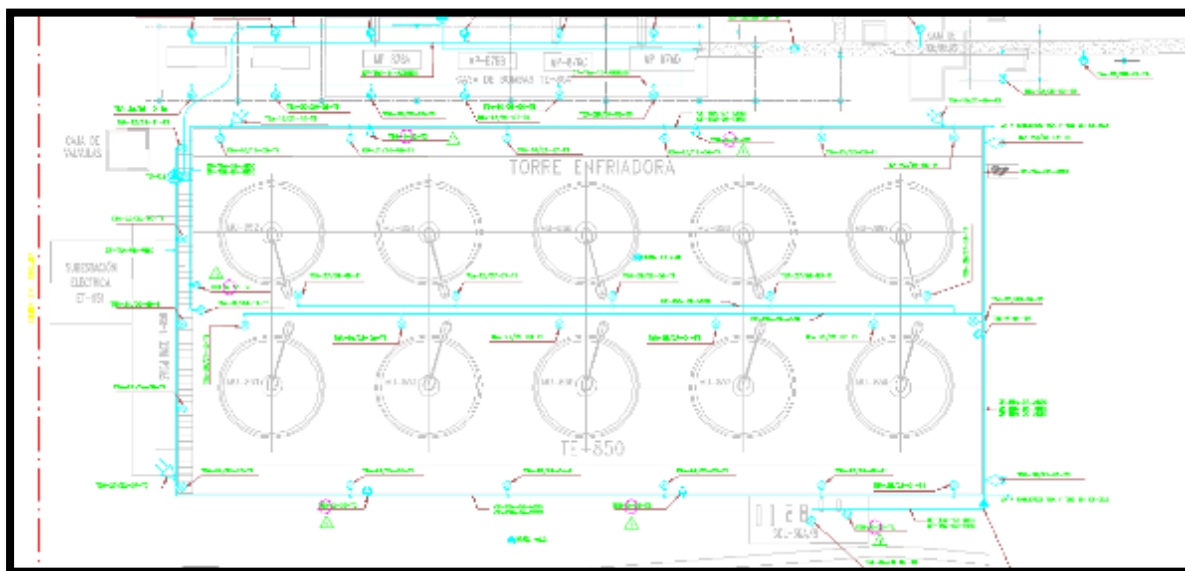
Vista en planta de la TE-850 (Fuente: archivo técnico de la Refinería de Barrancabermeja).
